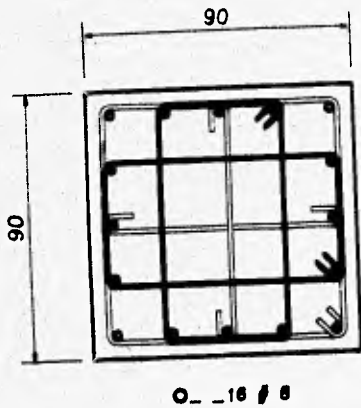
REFUERZO TRANSVERSAL EN ZONAS CENTRALES DE COLUMNAS, MODELO 1, Q=4
